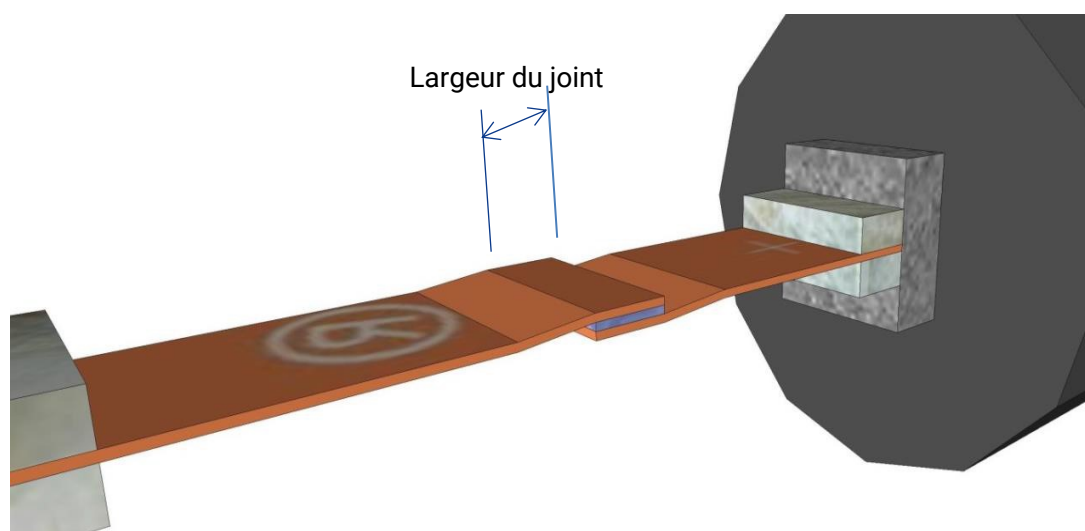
Essai de cisaillement sur raccord de membrane avec un collage au mastic-colle (non visible)
